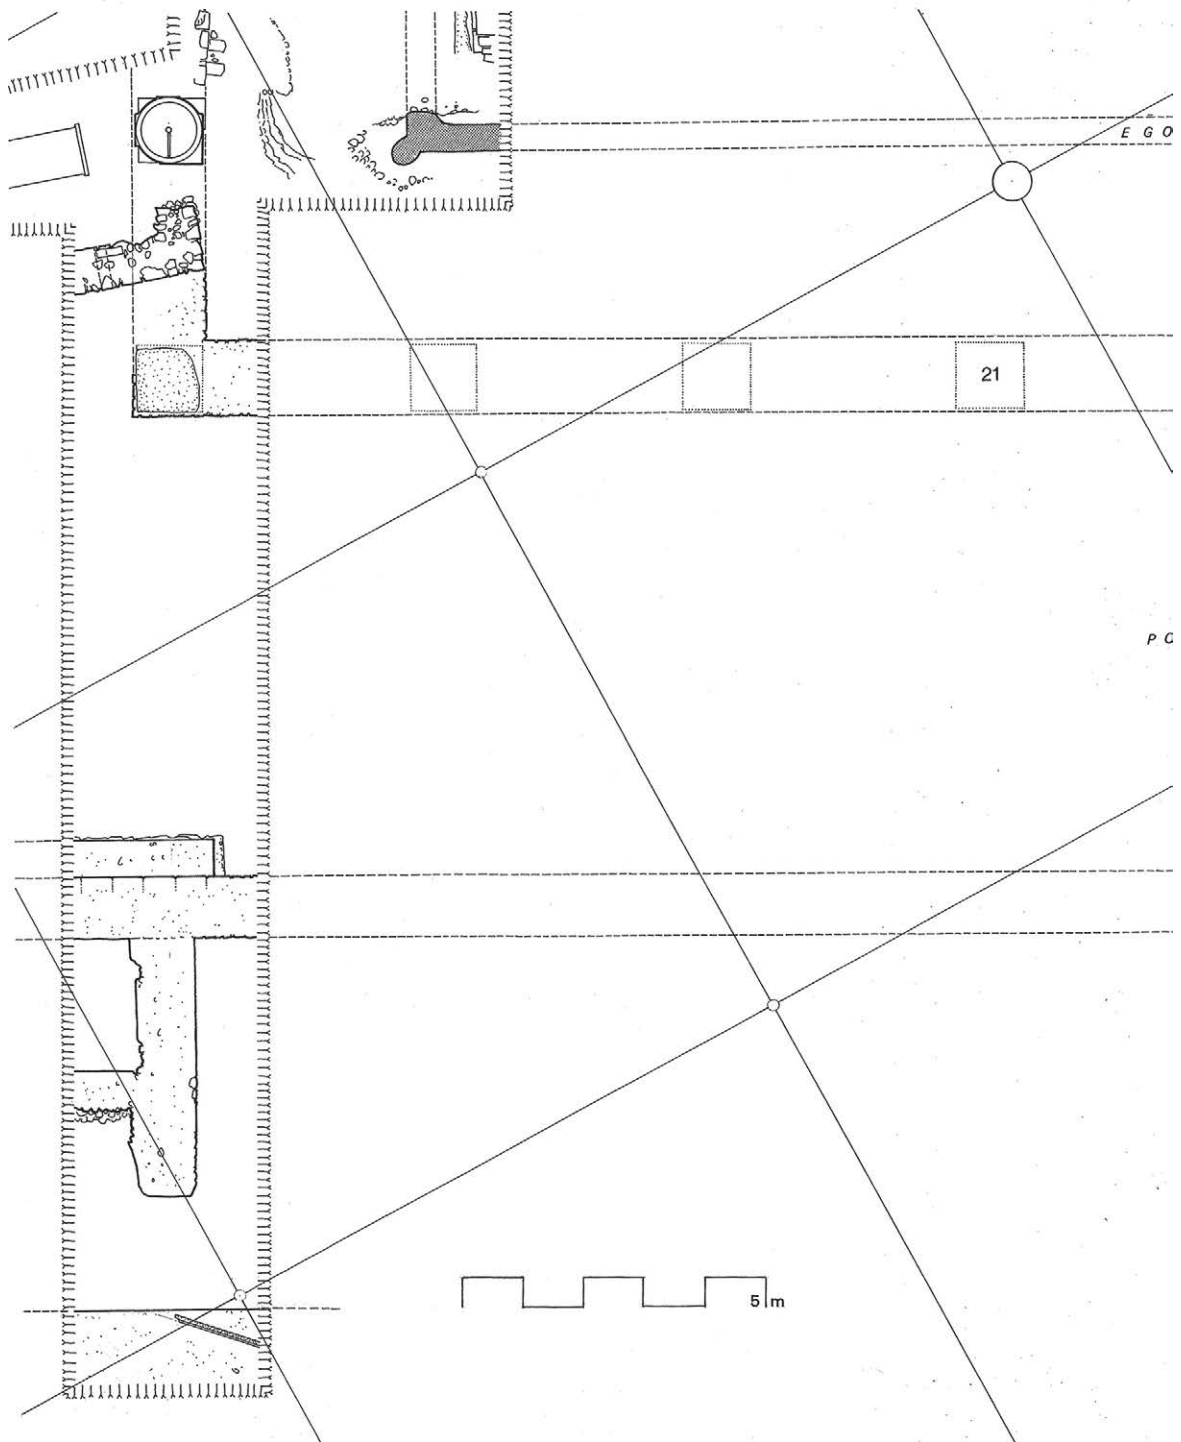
Plan de détail de la colonnade orientale (colonnes 17 à 21) (G. Hallier).
